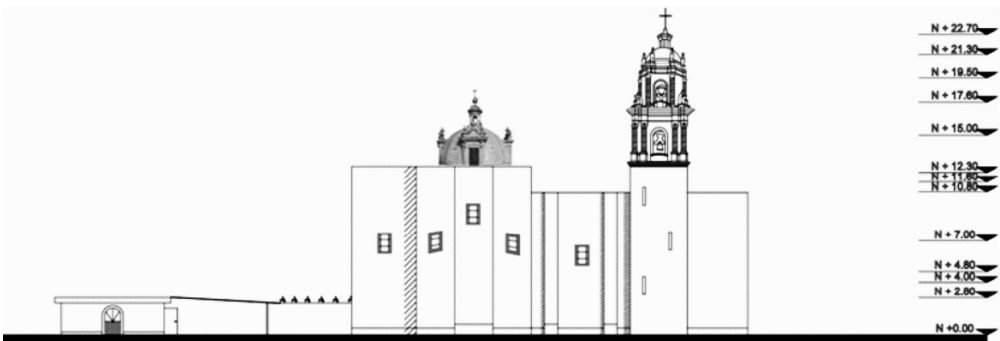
Fachada Norte. (Sánchez, N. Acervo Personal. 2008)
